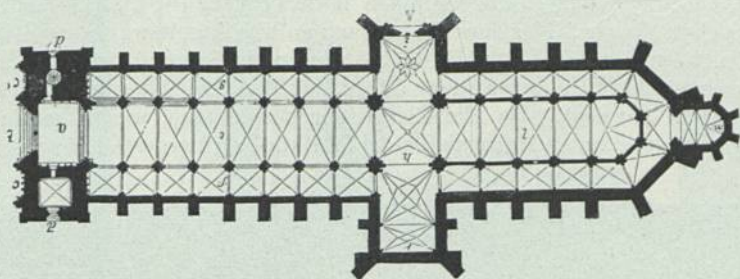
Grundriss des Doms zu Halberstadt
